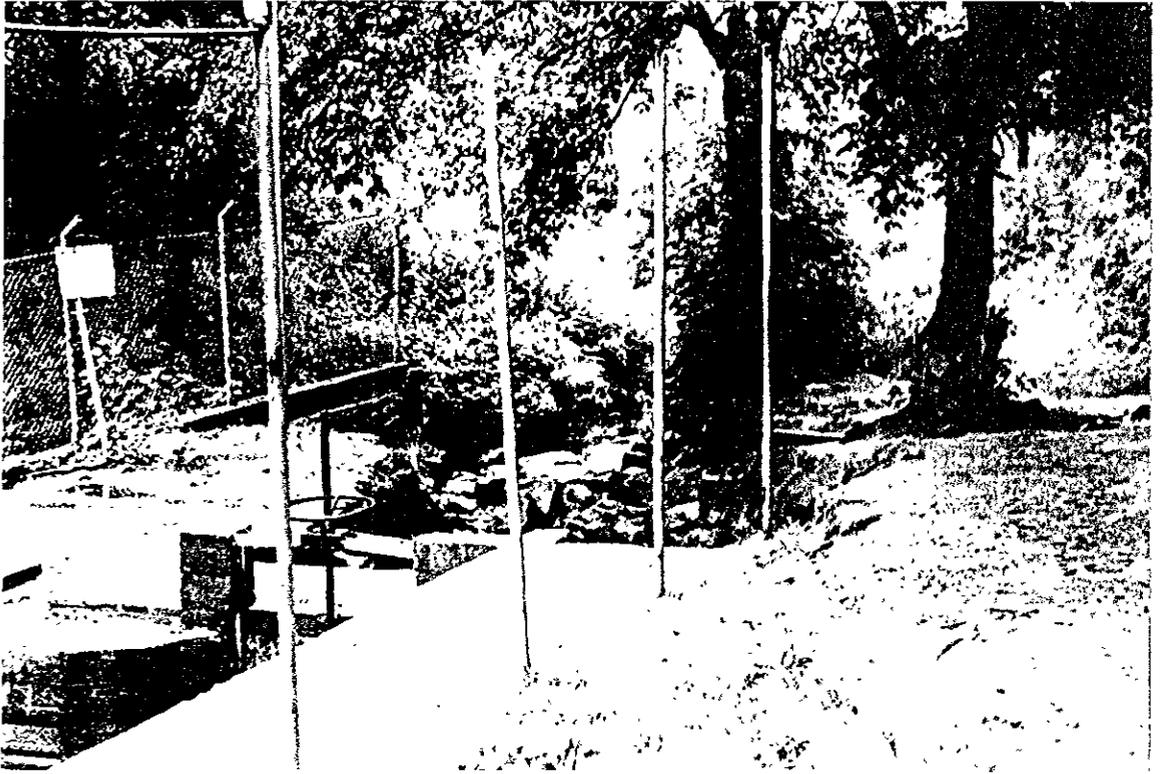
Actual represa de mampostería de donde se alimenta la planta potabilizadora Río Magdalena con una tubería de 4 pulgadas.
